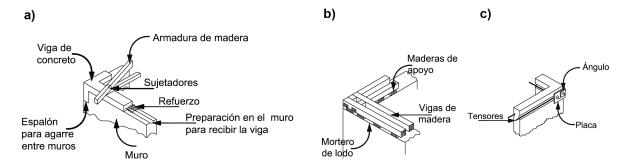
Refuerzo en viviendas de adobe: a) con viga cadena de concreto; b) con viga de madera; y c) con tensores de acero.
